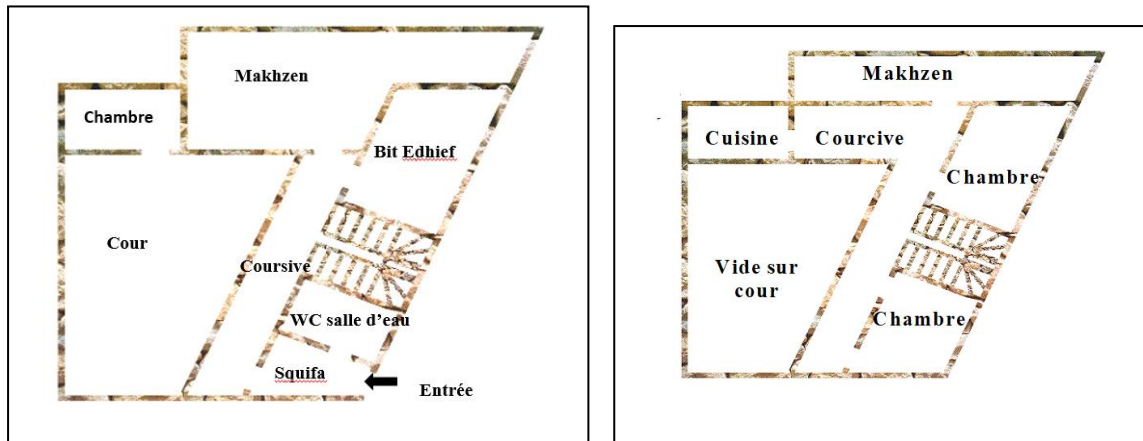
Plan du rez-de-chaussée et de l'étage du deuxième échantillon de maison dans le Ksar de Khanguet Sidi Nadji. Echelle : 1/200.
